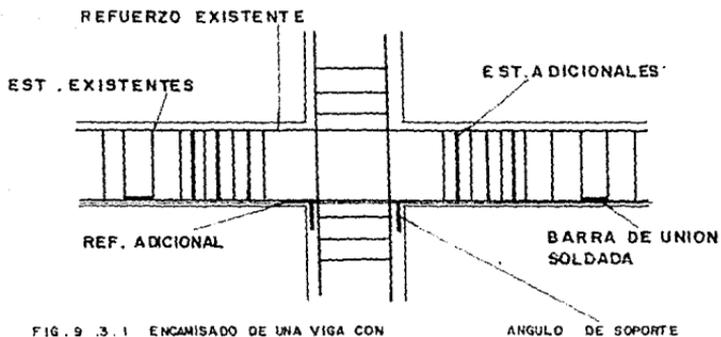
ENCAMISADO DE UNA VIGA CON CONCRETO REFORZADO POR FLEXION.
